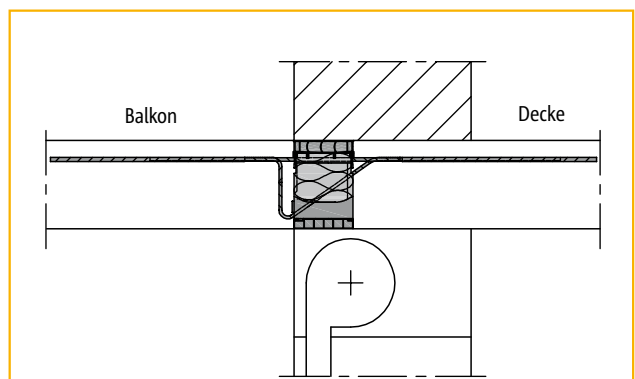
Einschaliges Mauerwerk mit Rolladenkasten bei deckengleichem Balkon
